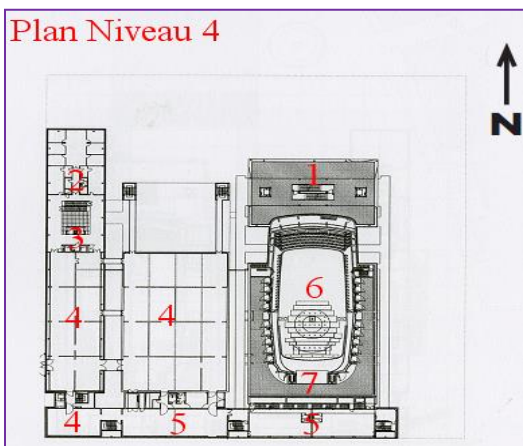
Plan niveau (4,5) : Source www.vitruvio.ch
